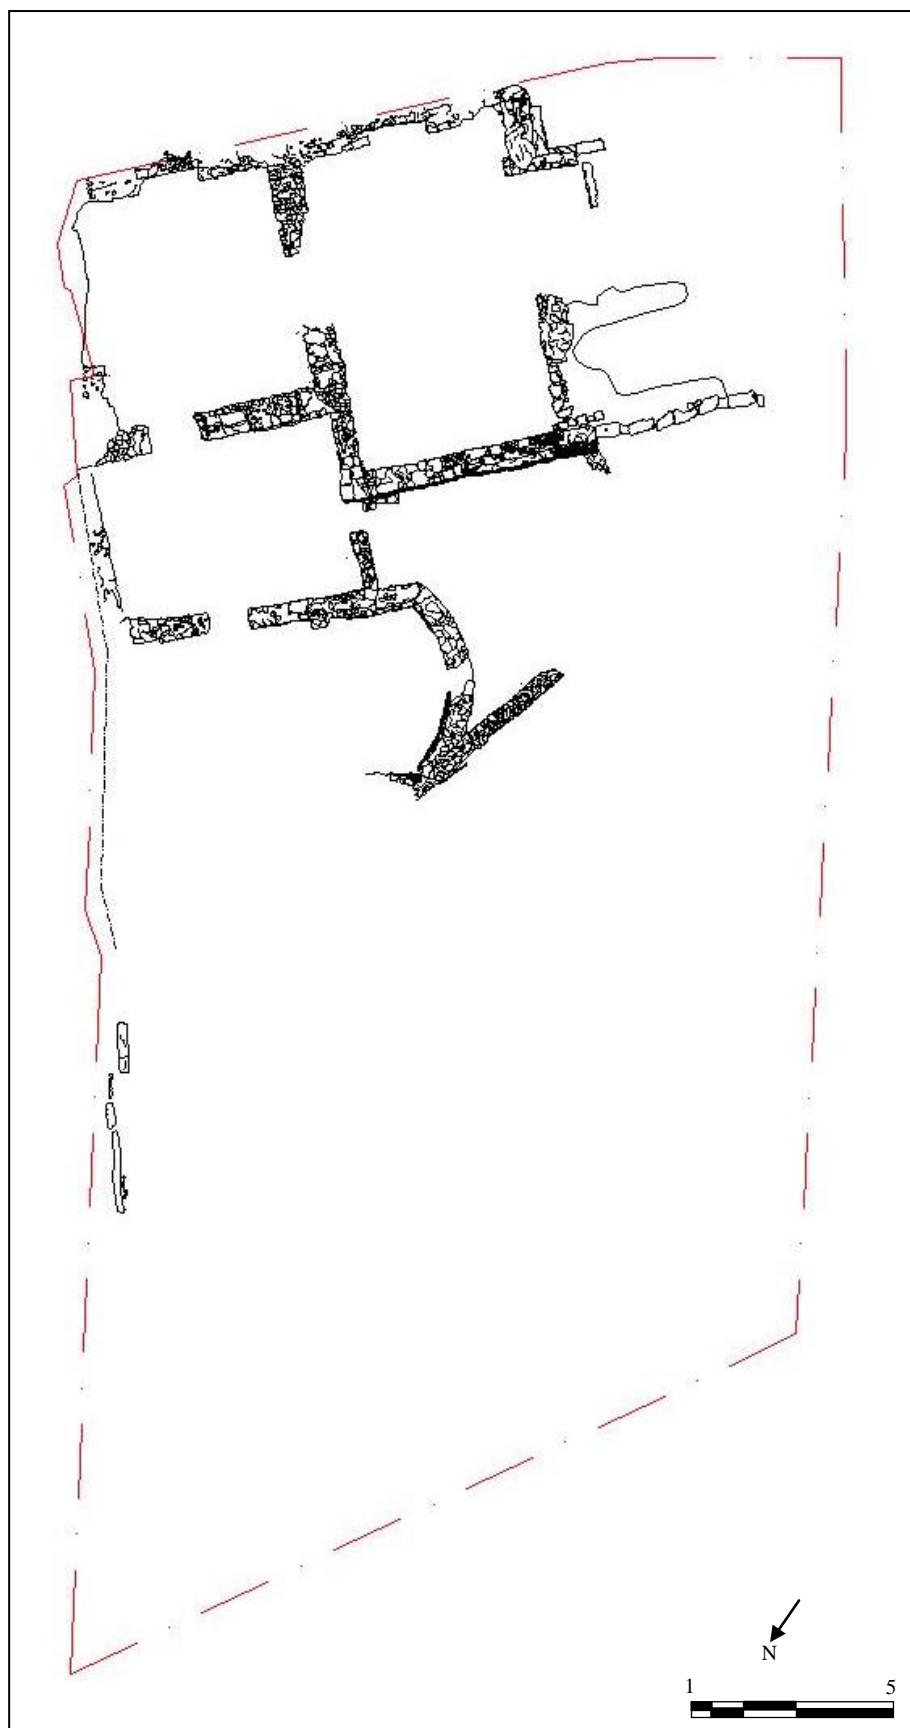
Planimetria ricavata a quota +2.00m con la caratterizzazione delle strutture.
